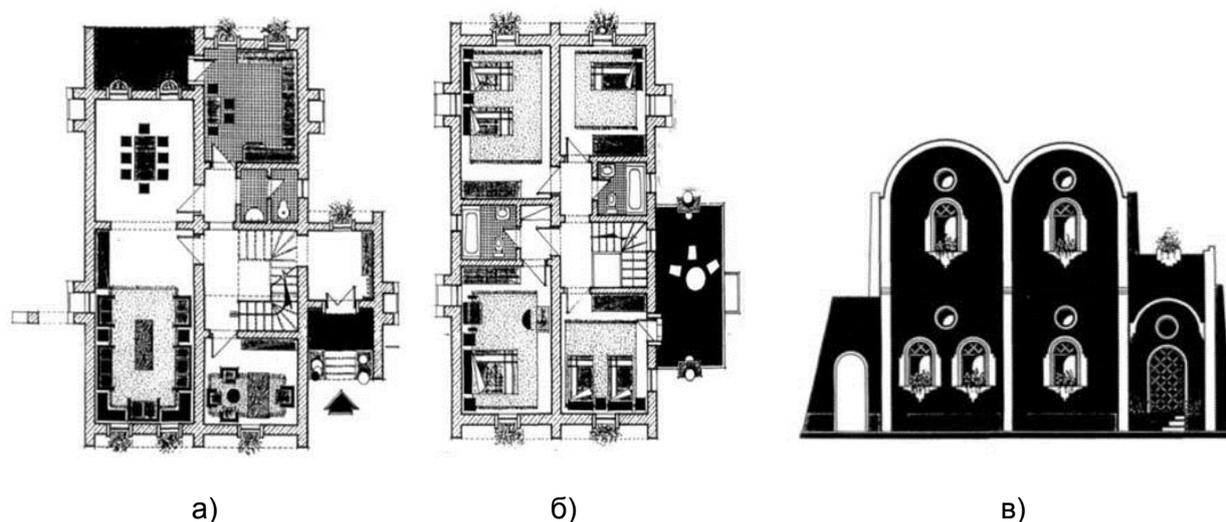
Одноквартирное МЖЗ с садом (для курдов). Семья из 6 человек: а) план 1-го этажа; б) план 2-го этажа; в) фасад (рисунки автора)
